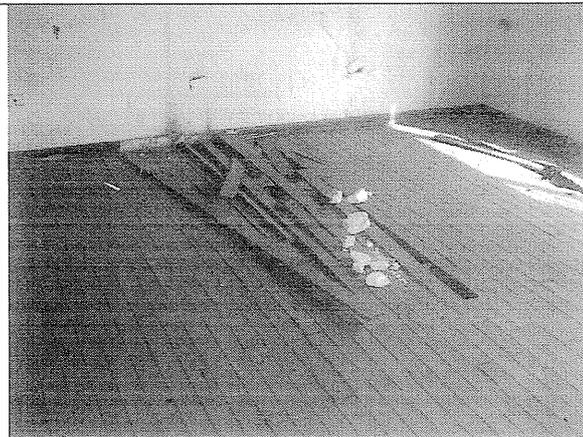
Deterioro en el tablado del entrepiso del tercer piso.
